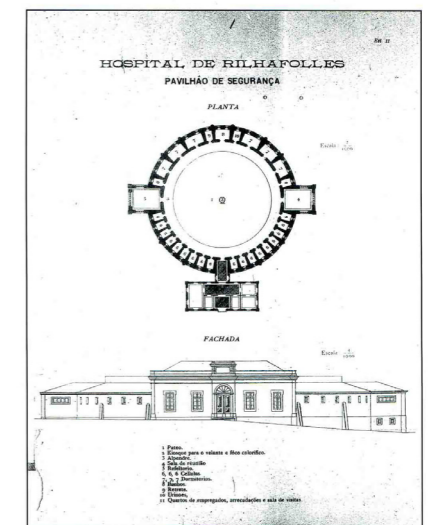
Planta e Fachada do Pavilhão de Segurança, 1894
